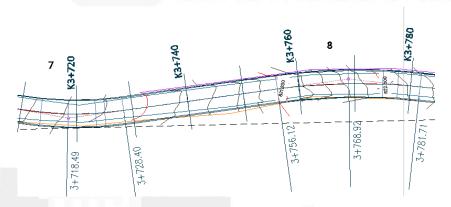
PLANTA ZONA DE INTERVENCION
